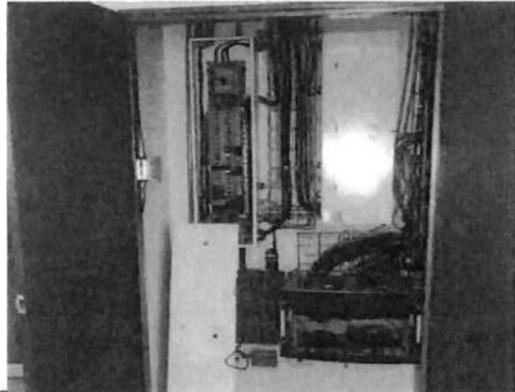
SEXTO PISO tablero eléctrico costado oriental
